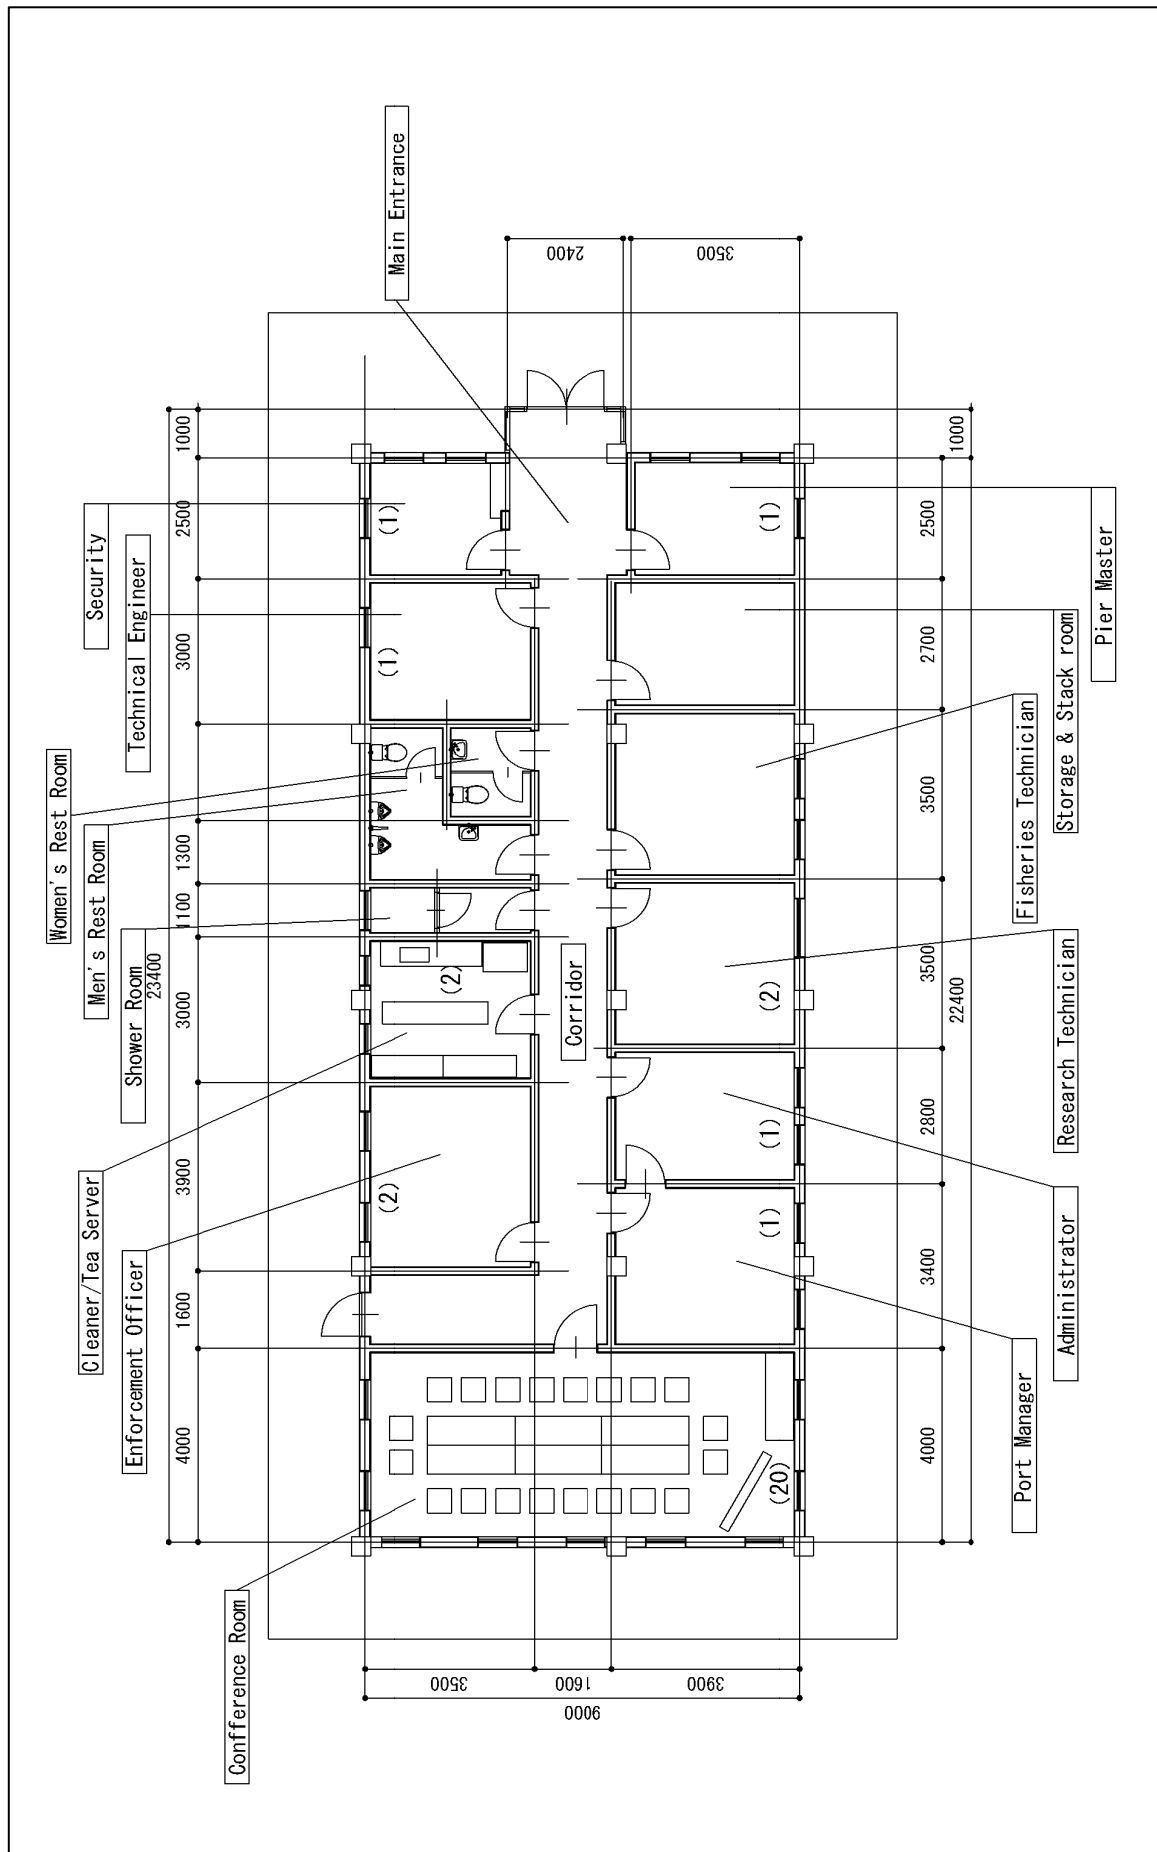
(4) 管理棟平面図 (プロビデンス漁港)
